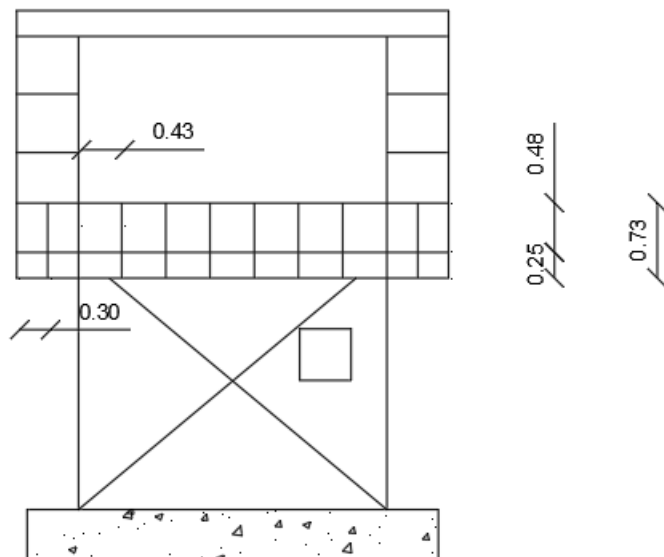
Prospetto Ovest dell'edificio a seguito delle modifiche.
